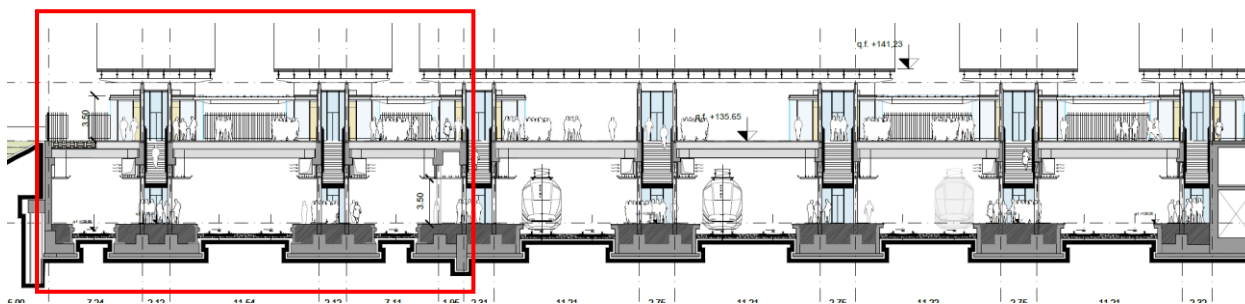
Sezione trasversale banchine con indicazione delle banchine di ampliamento
